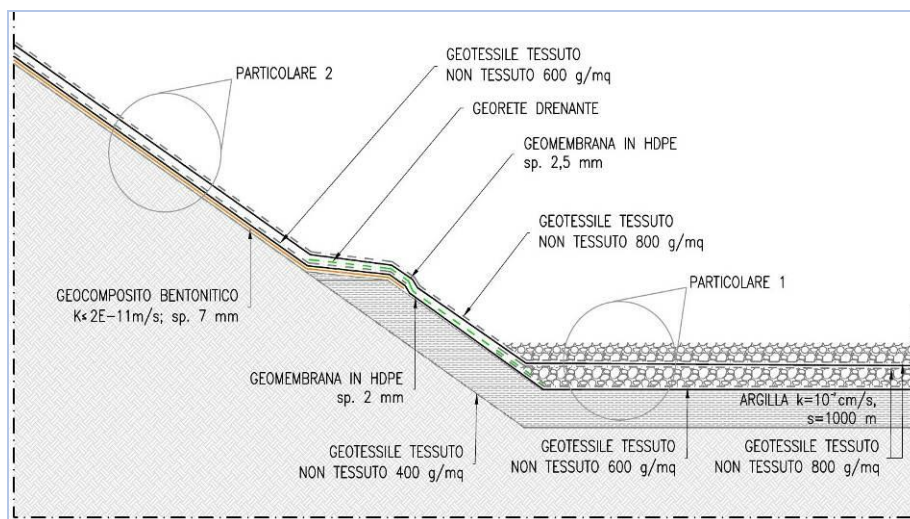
Sezione tipologica di impermeabilizzazione del fondo e delle pareti della discarica.
